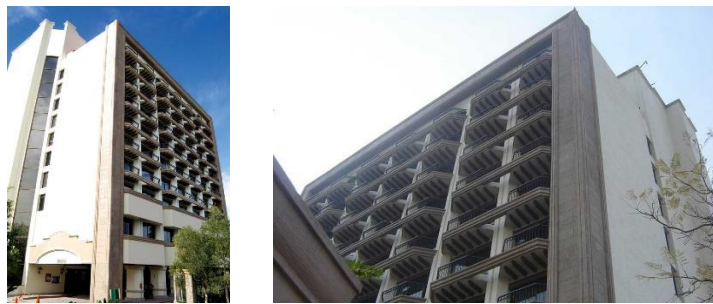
y 109. Pilar y muro con acabado de fibra de vidrio
